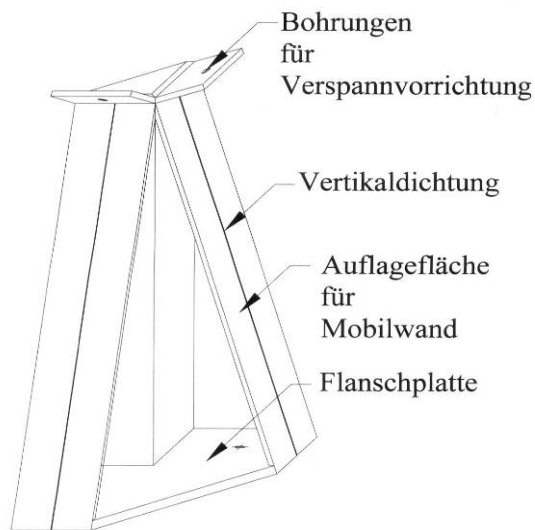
Ausführung einer schrägen Eckstütze für Dammbalken [70]
